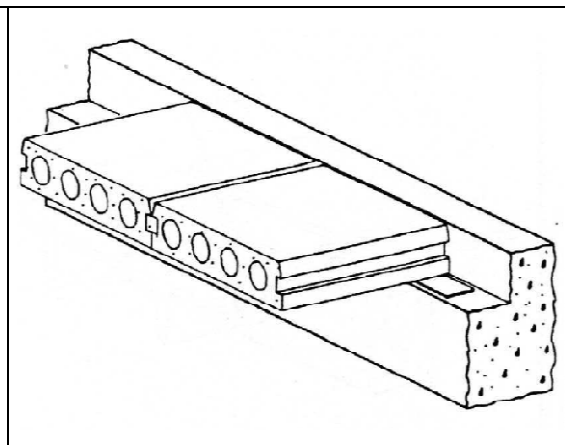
Ligação de lajes alveolares simplesmente apoiadas sobre neoprene, perpendiculares à laje de piso (PCI)
